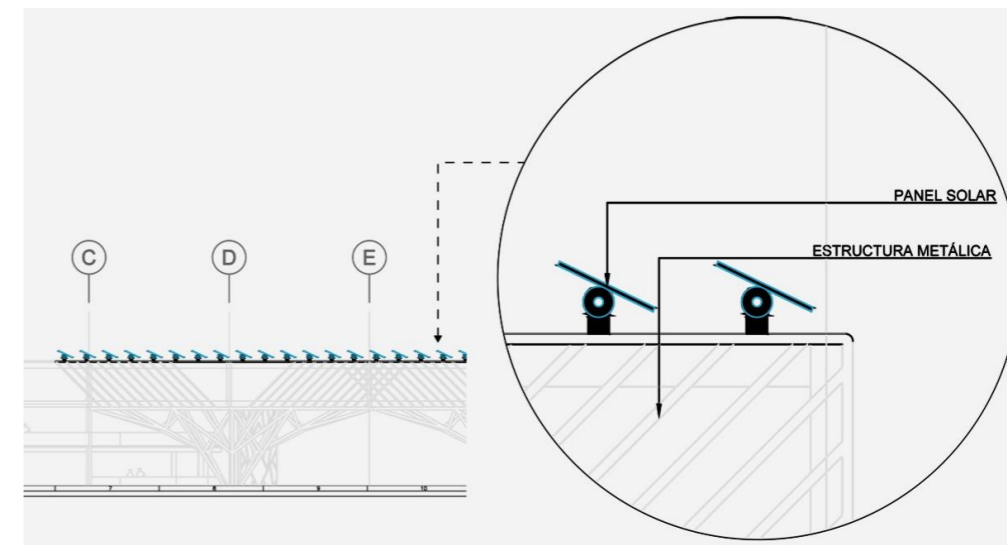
Detalle de paneles solares sobre la cubierta del restaurante
